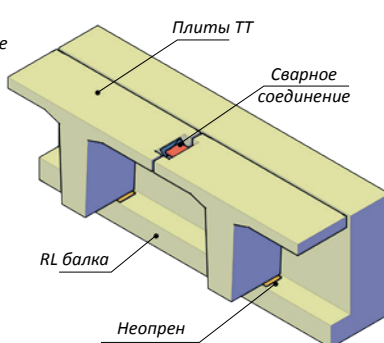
Соединение полок плит ТТ при формировании жесткого диска перекрытия.
